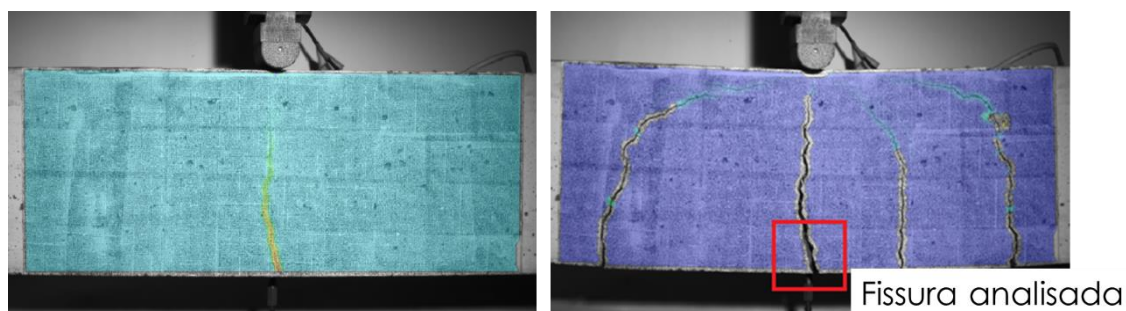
Viga V3-REF - Início da fissuração e na ruptura
